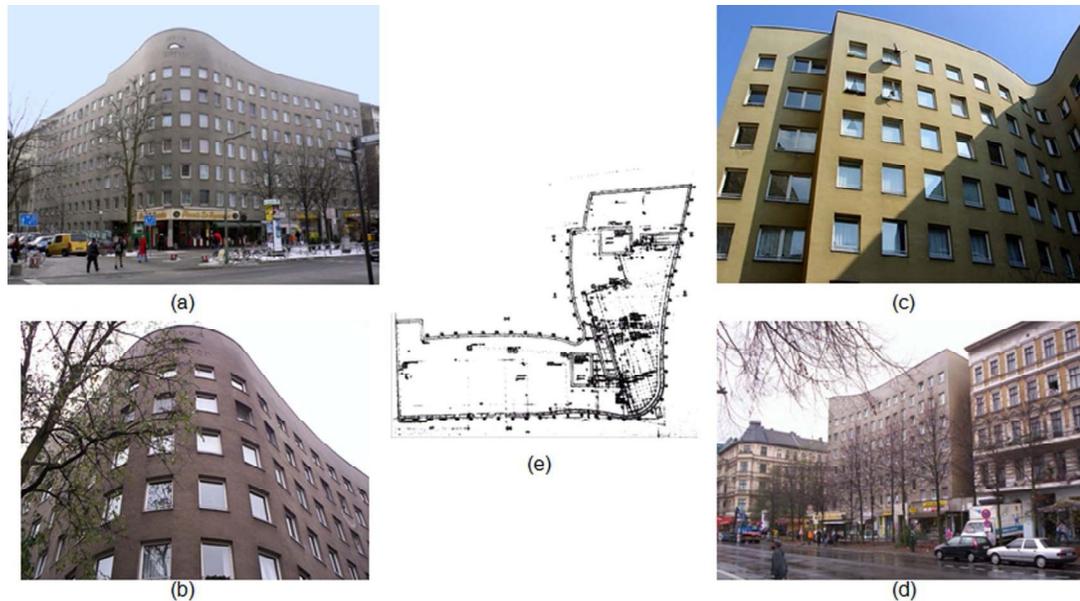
Álvaro Siza, Viviendas en esquina del barrio de Kreuzberg, Berlín, Alemania, (1980-1984): (a) Vista general, (b) Detalle exterior – fachada principal, (c) Detalle exterior- fachada posterior, (d) Vista del edificio y el entorno, (e) Planta arquitectónica.
